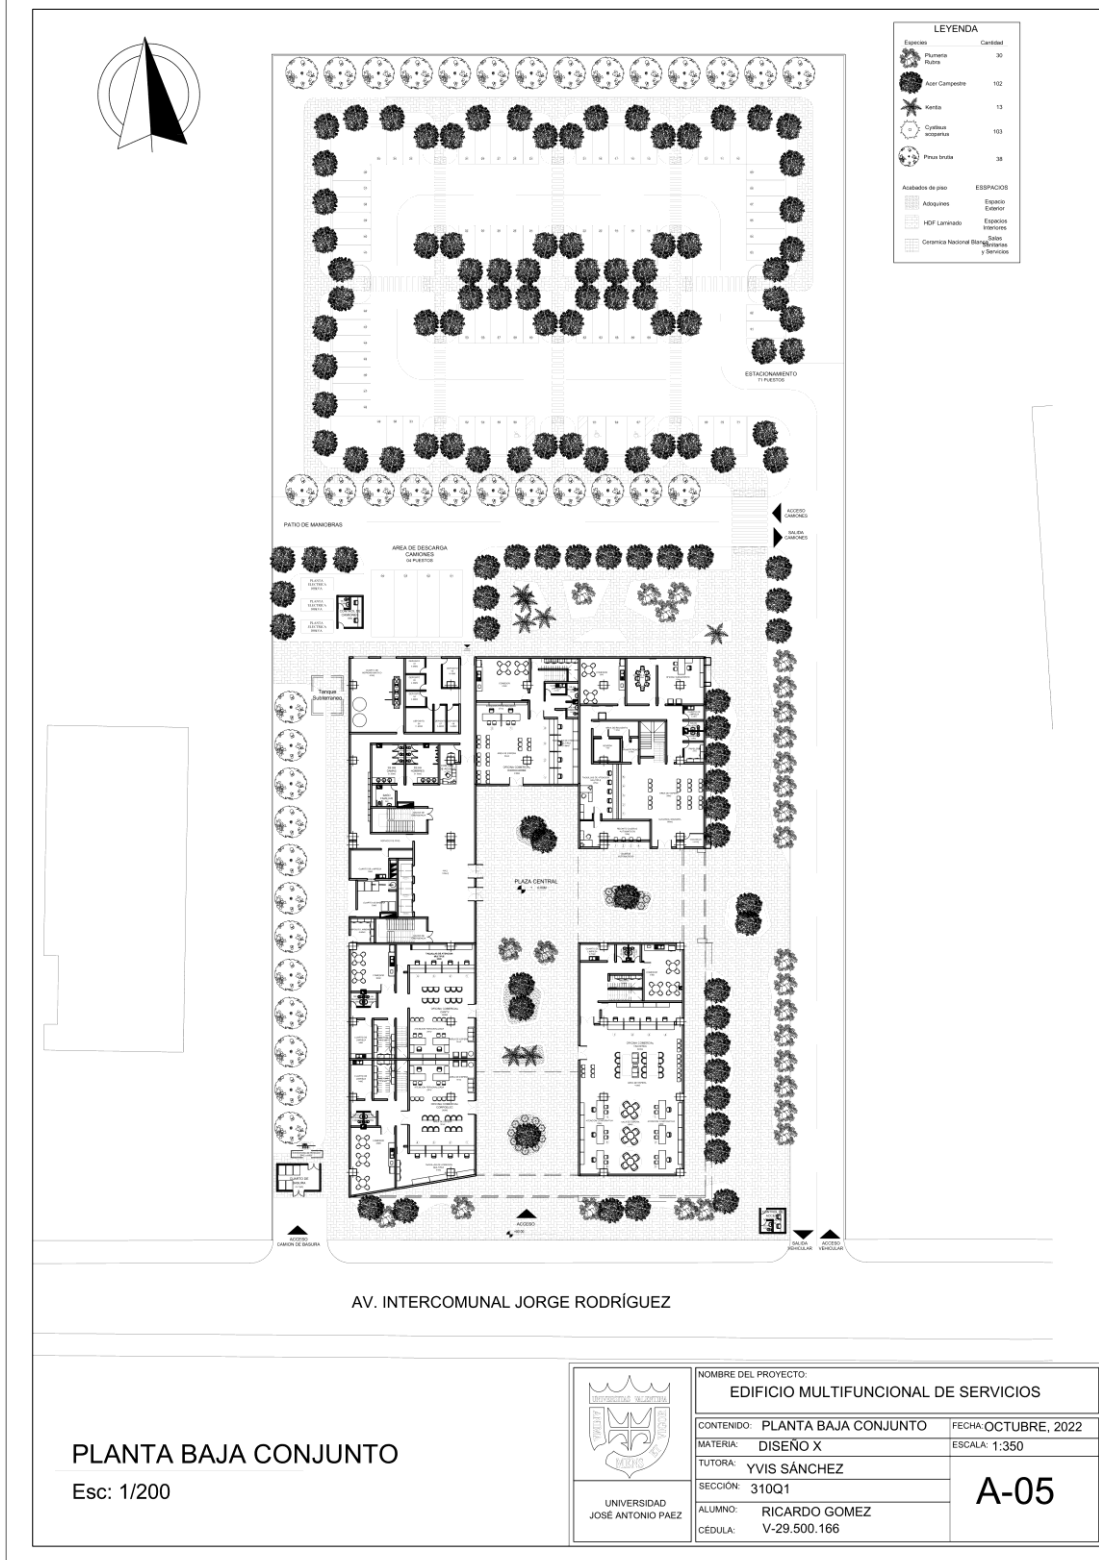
Planta baja conjunto. Fuente: El Autor (2022).
